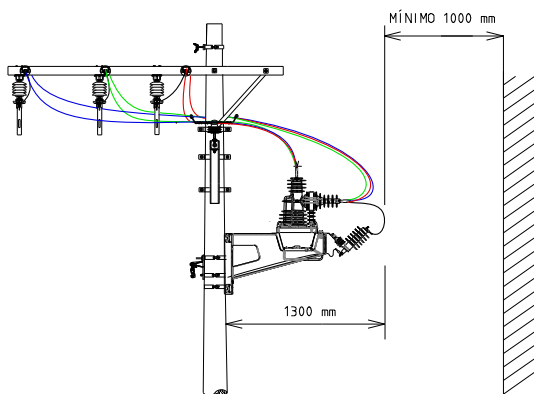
Afastamento horizontal entre ponto energizado e parede de edificação.
